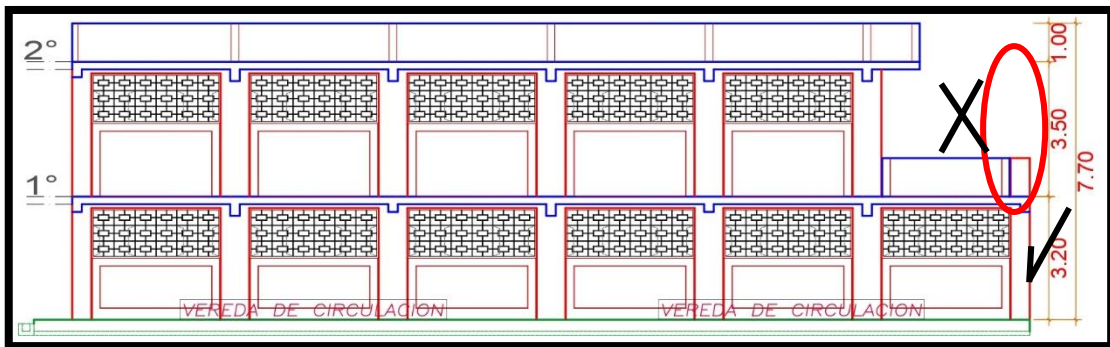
Plano Elevación posterior _MOD - 06: discontinuidad de columnas en eje 7-7 del 2° piso.
